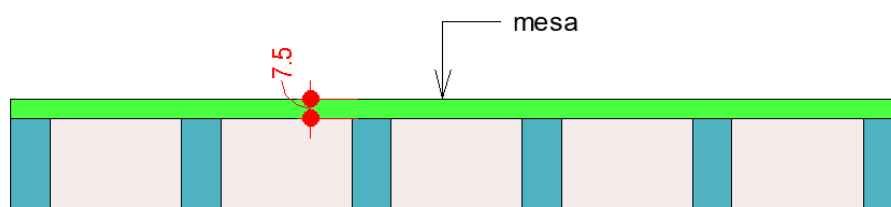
Vista frontal da laje nervurada lisa bidirecional - espessura da nervura
